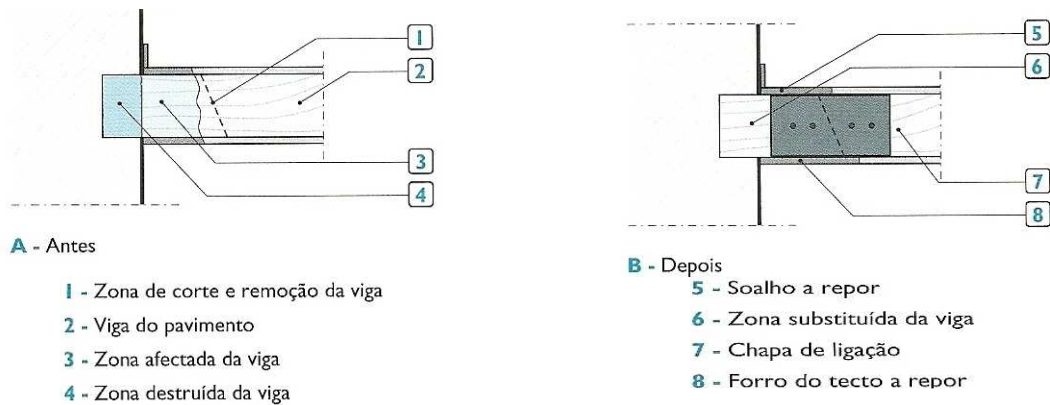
Substituição de extremidade de viga e ligação com chapas metálicas aparafusadas, (Fonte [31])
